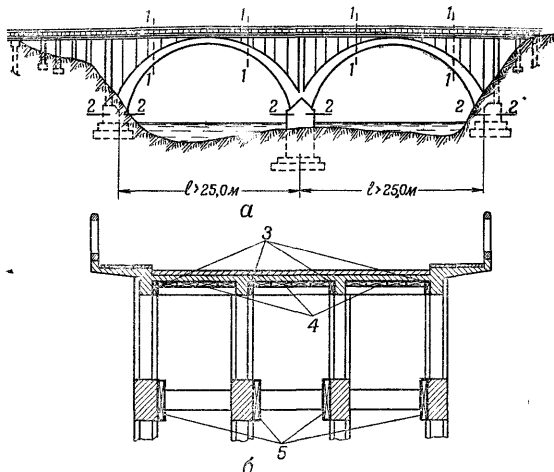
Подрывание железобетонного моста с пролетным строением на бесшарнирных арках:
